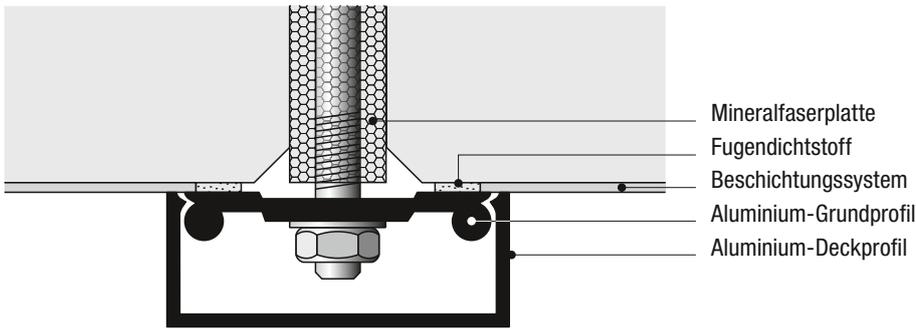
Fugenausbildungen mit Alu-Grund- und Deckprofilen
